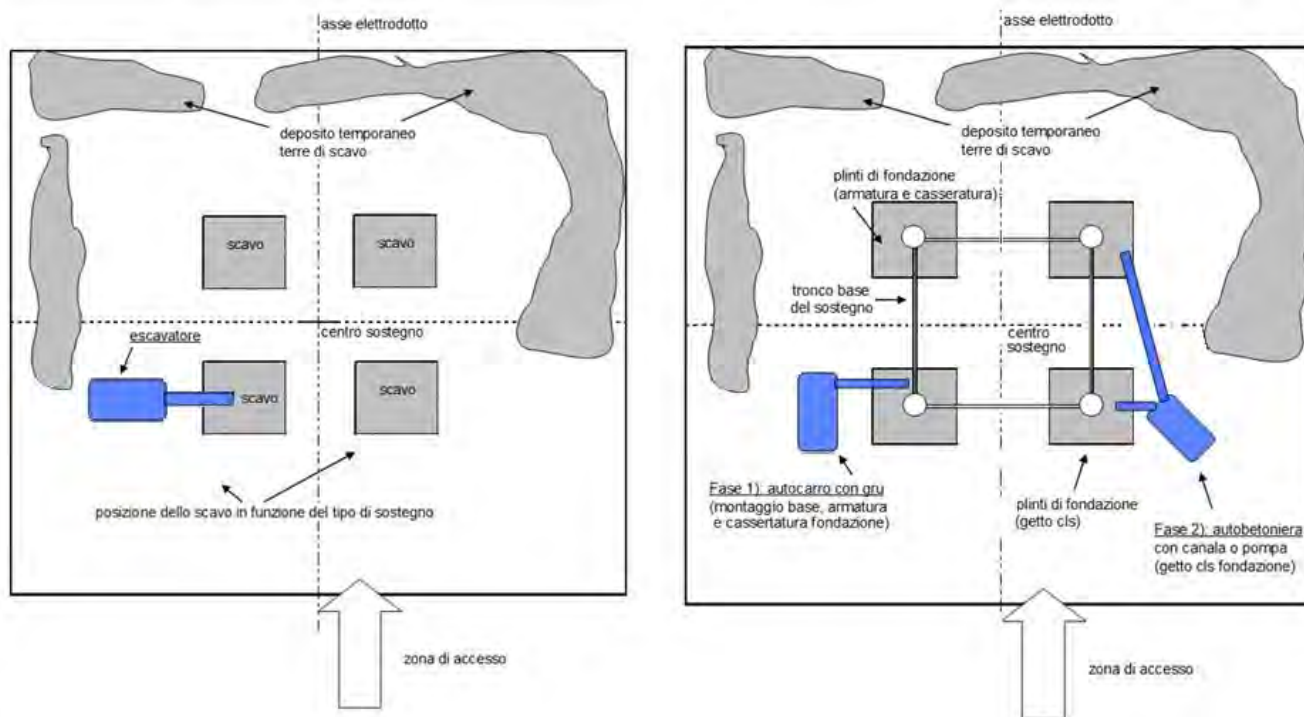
Planimetria dell'Area Sostegno (scavo di fondazione - getto e basi) – Tipologico
